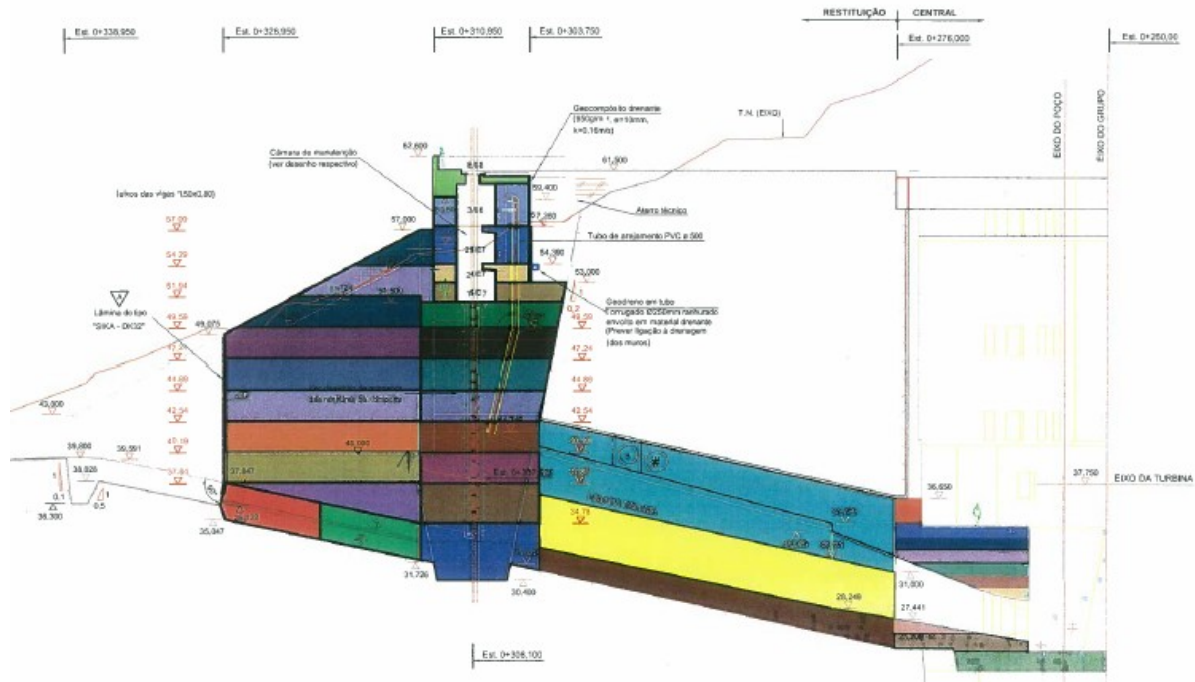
Faseamento das betonagens da galeria de restituição (Fonte: PTRE)
